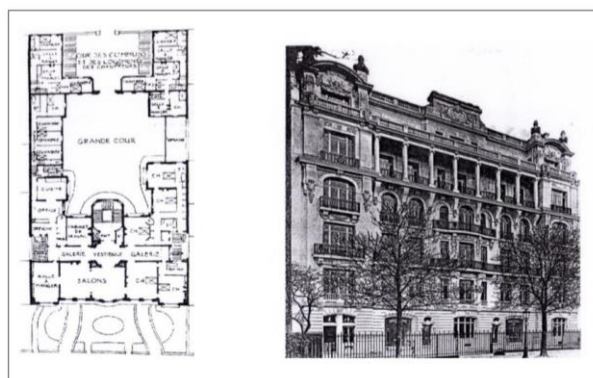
Plan et façade d'un immeuble de rapport du boulevard Maillot à Neuilly-sur-seine. P.Navarre et R.Rousselot, architectes, 1910,1911.
